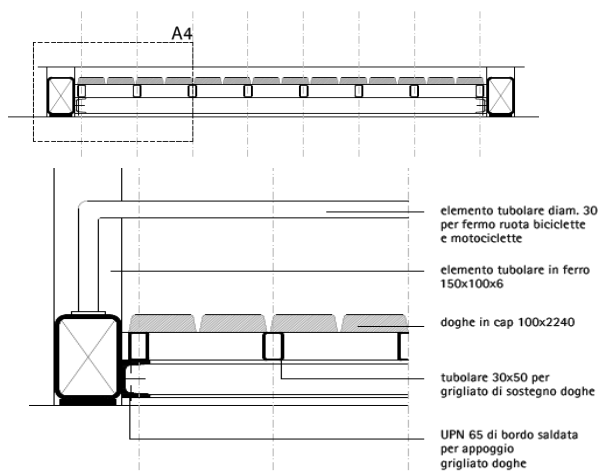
Sezione trasversale e dettaglio del piede d'appoggio.
